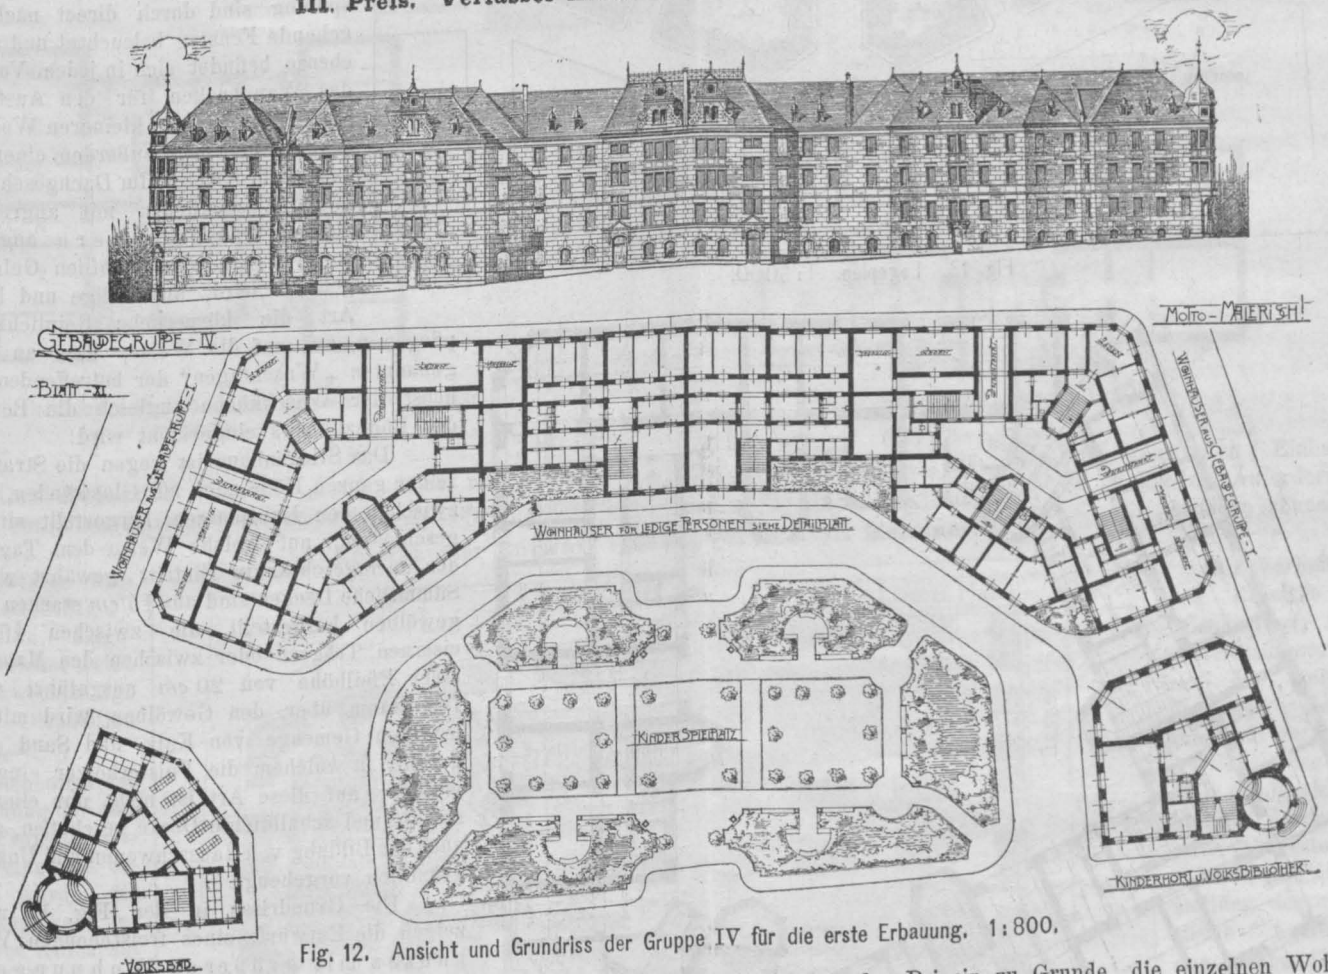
Ansicht und Grundriss der Gruppe IV für die erste Erbauung. 1:800.
